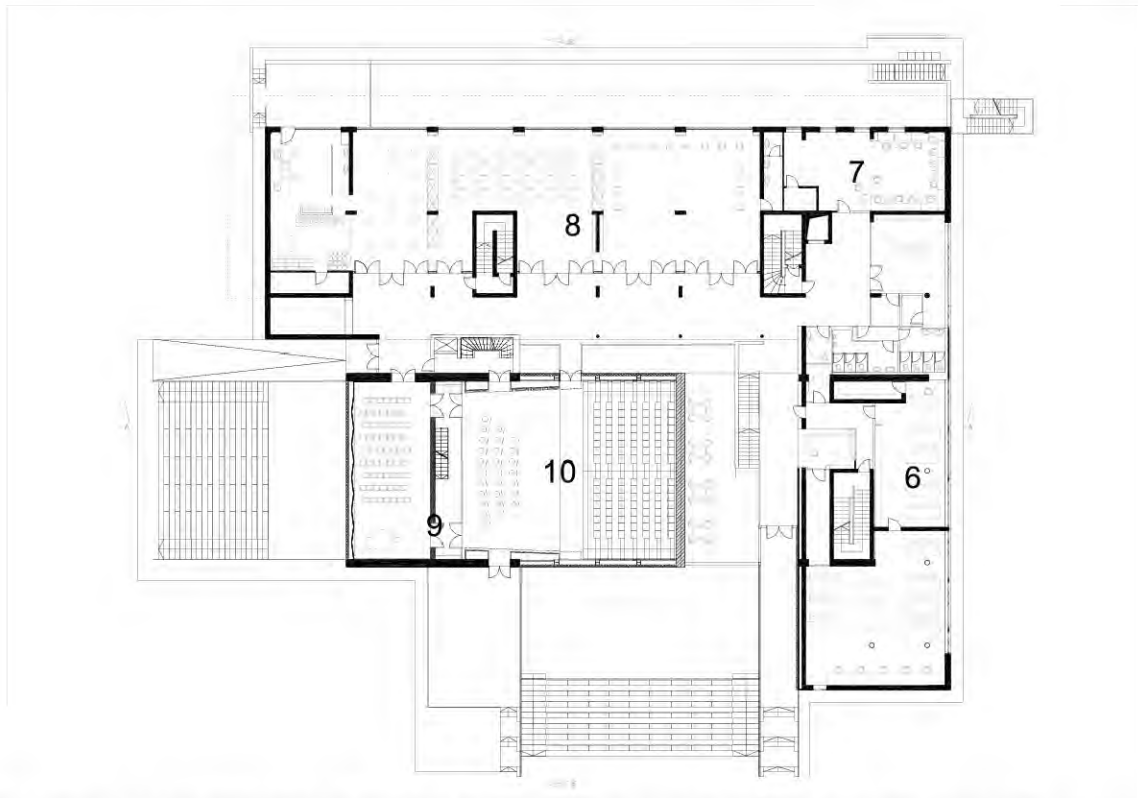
Planta baja, Escuela de Música y Artes / LTFB Studio. Fuente: ArchDaily
